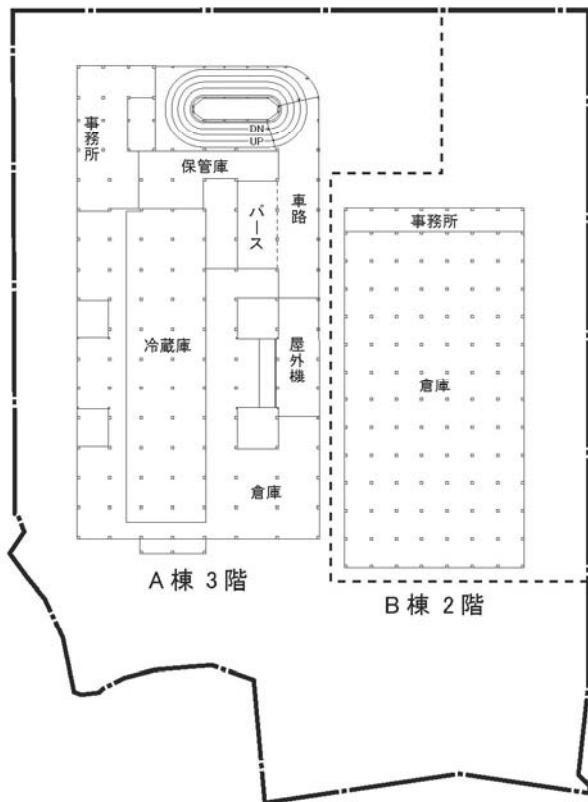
(2) 計画建築物平面図 (A棟3階・4階、B棟2階・3階)
